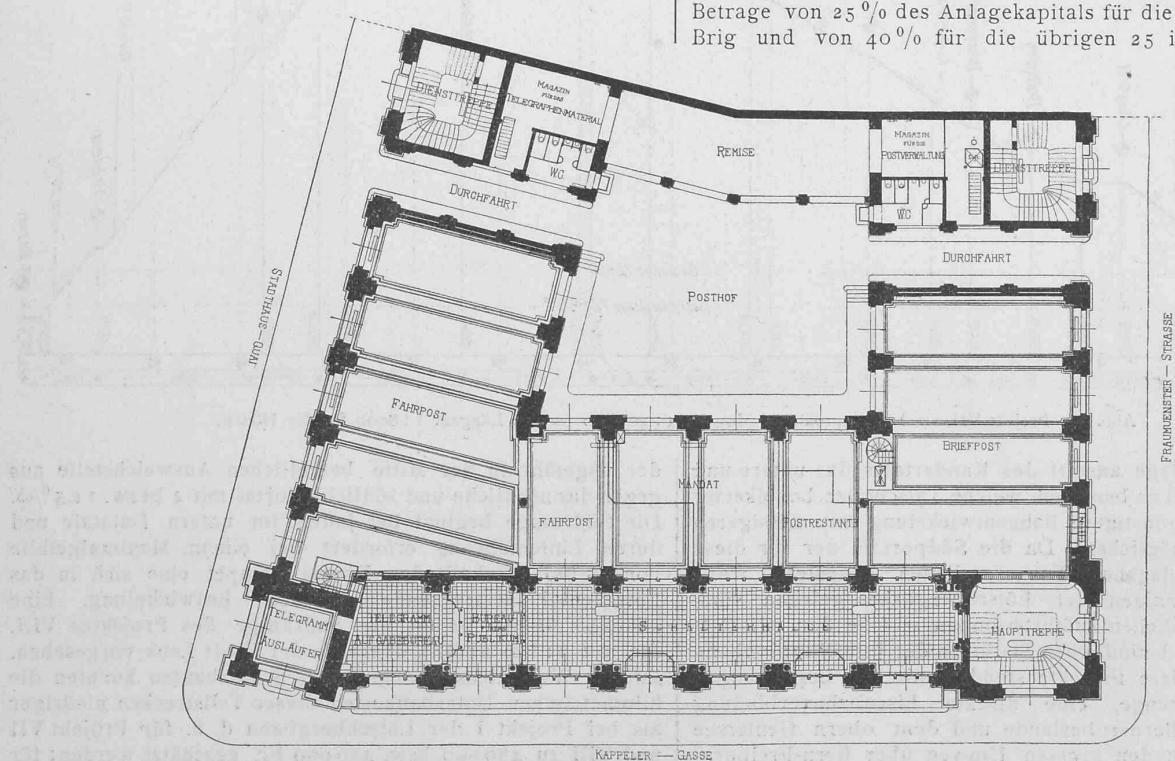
Grundriss vom Erdgeschoss. — Massstab 1:500.
